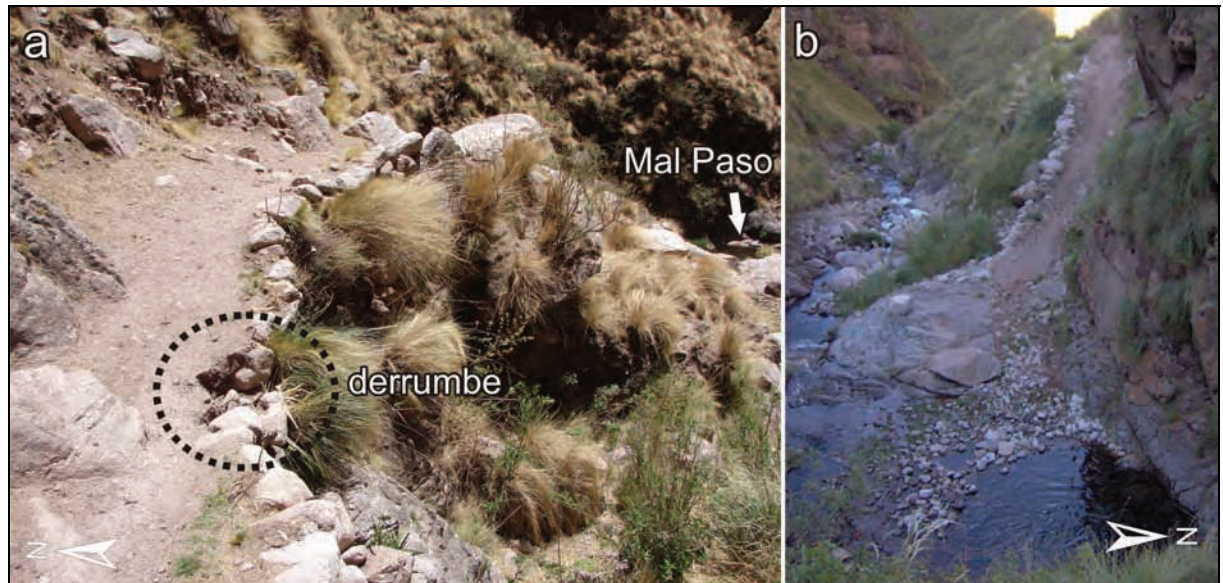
Mal Paso. Camino con talud ladera abajo y excavación ladera arriba:
